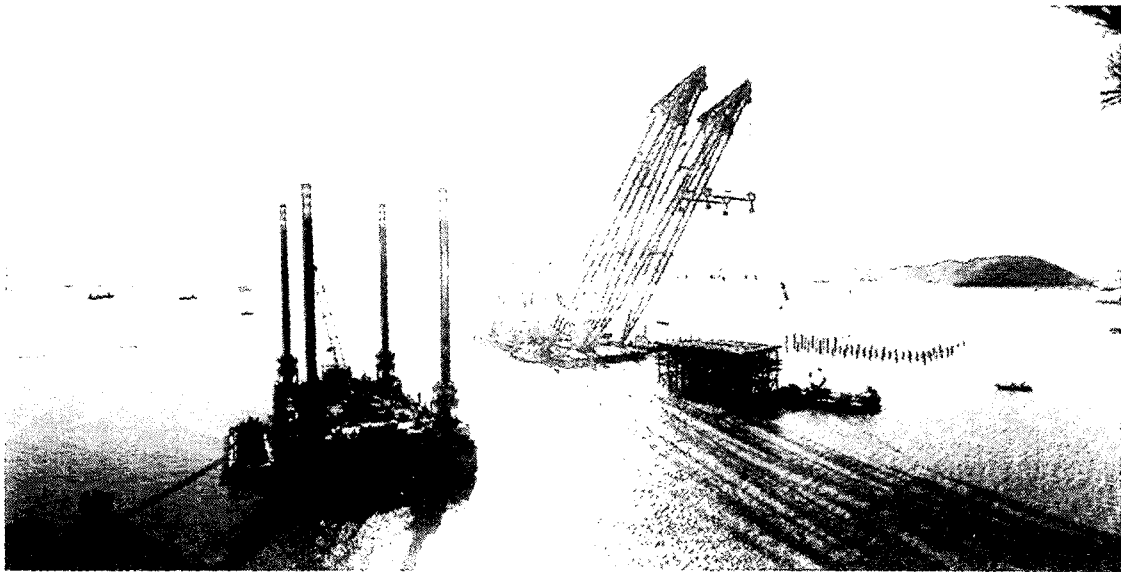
3000ton Crane을 이용한 Guide Frame 거치 전경
